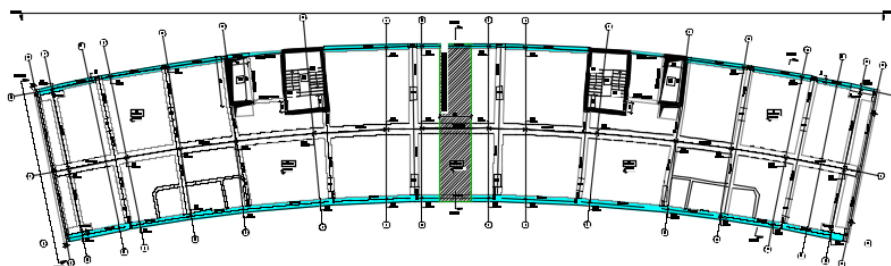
Localização das ligações aço-betão de fachada.[SE2P]
